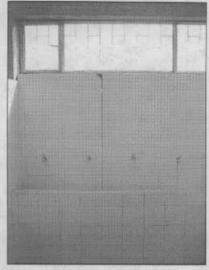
Grietas piso y muro del baño nuevo. Fachada.
